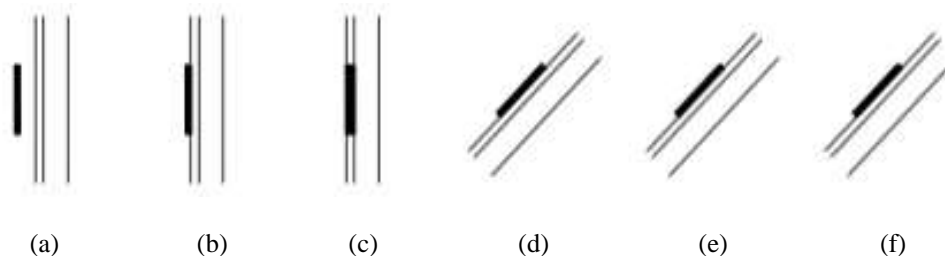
Esquema das possíveis instalações técnicas dos painéis solares em fachada (adaptado de [4]).
